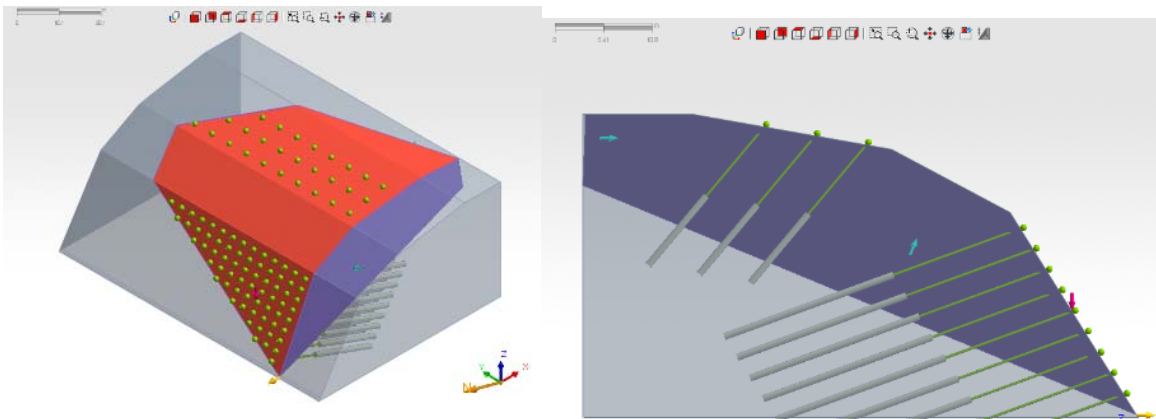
Modelo 3D con anclajes perfil 6
